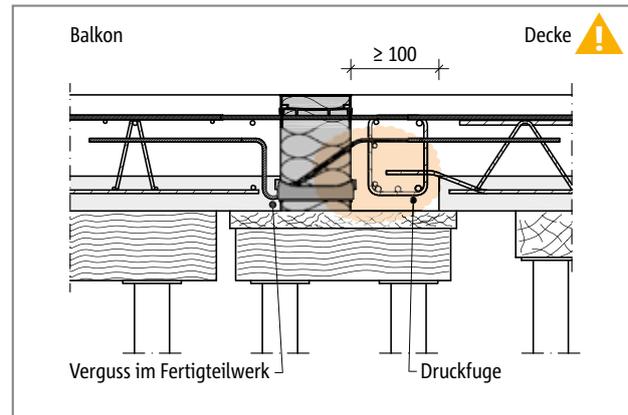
Schöck Isokorb® Typ KFXT: Druckfuge deckenseitig in Verbindung mit Elementplatten; indirekte Lagerung
